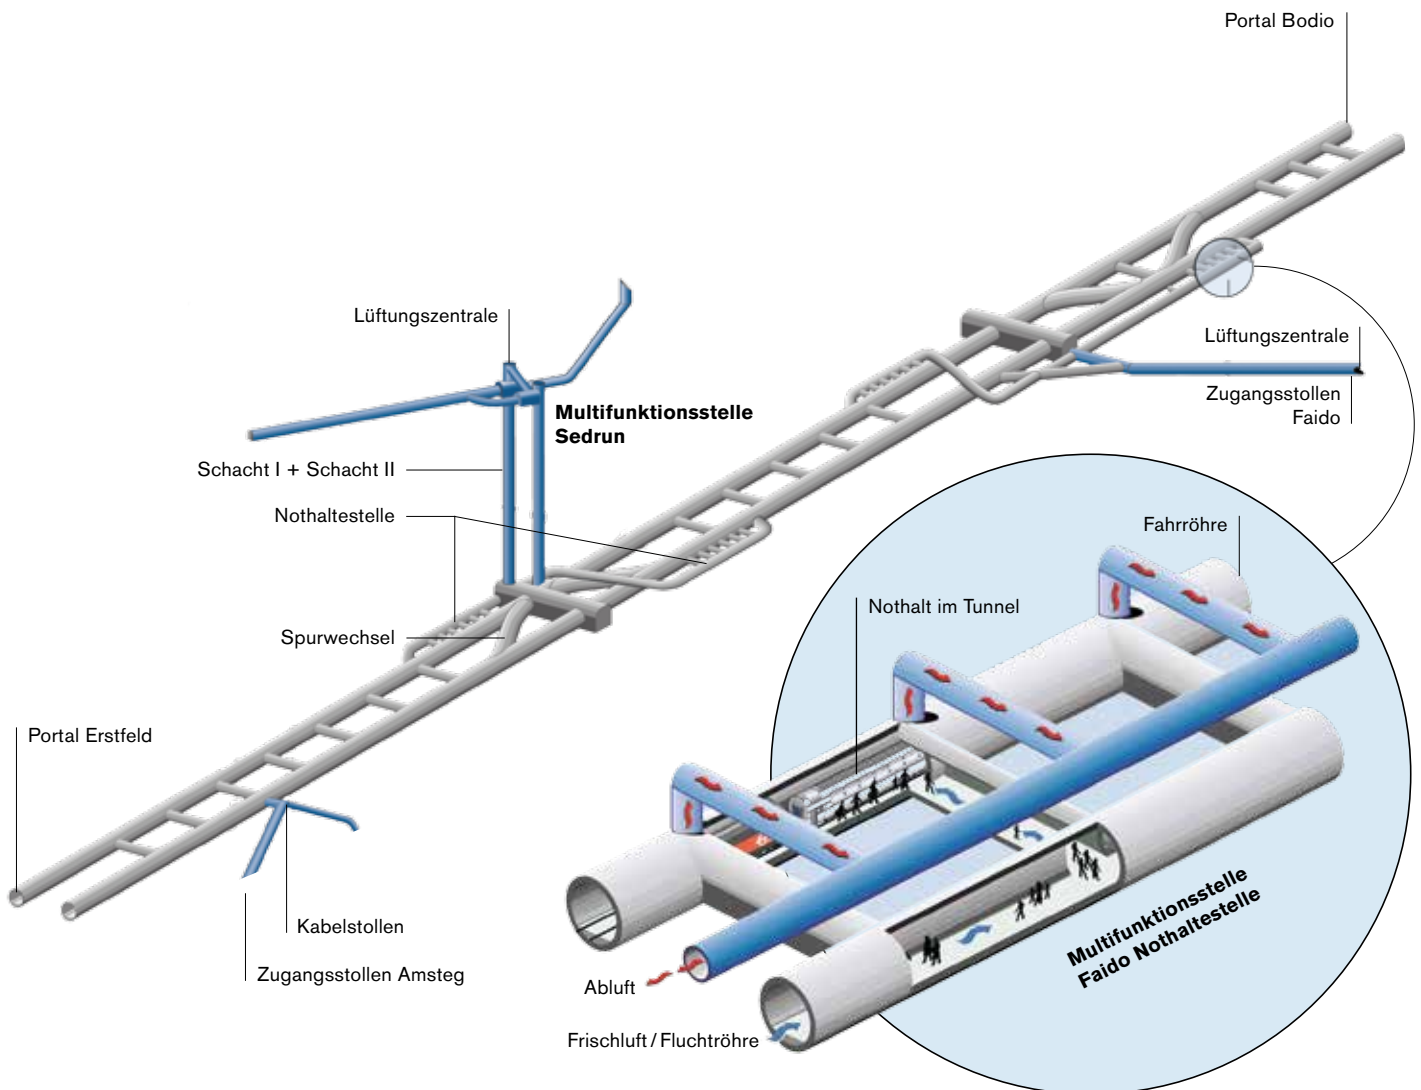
Schema Tunnelsystem GBT mit Nothaltestelle und Lüftung ©AlpTransit Gotthard AG
